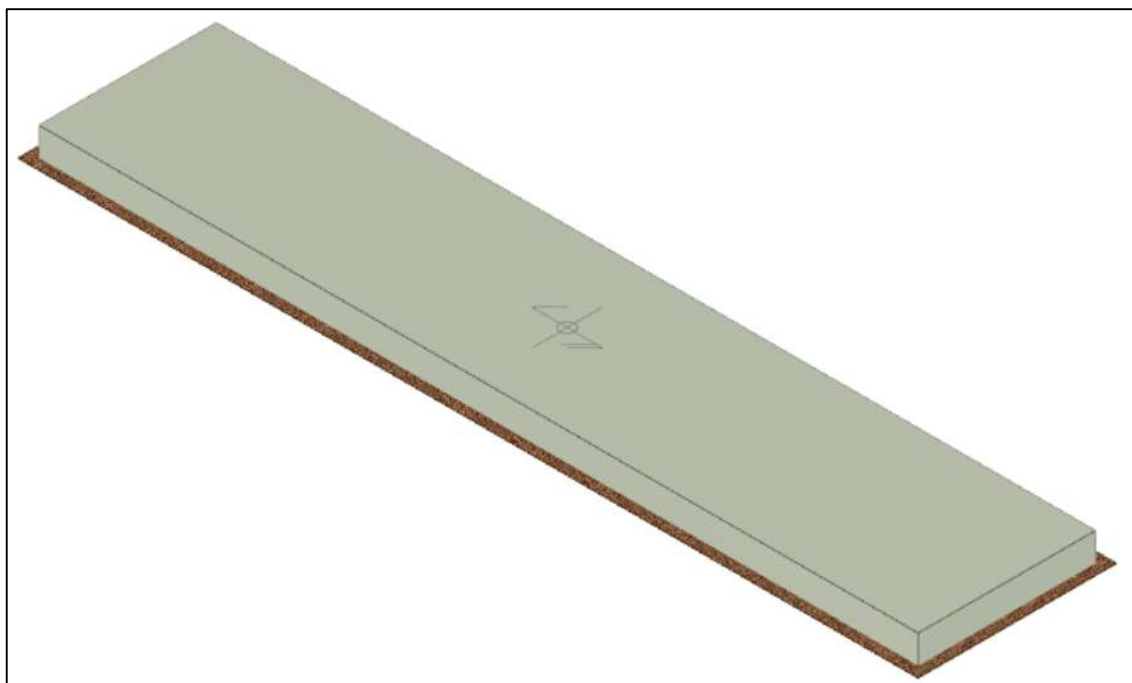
vista tridimensionale della fondazione della PLATEA PER L'AREA DI ACCUMULO
